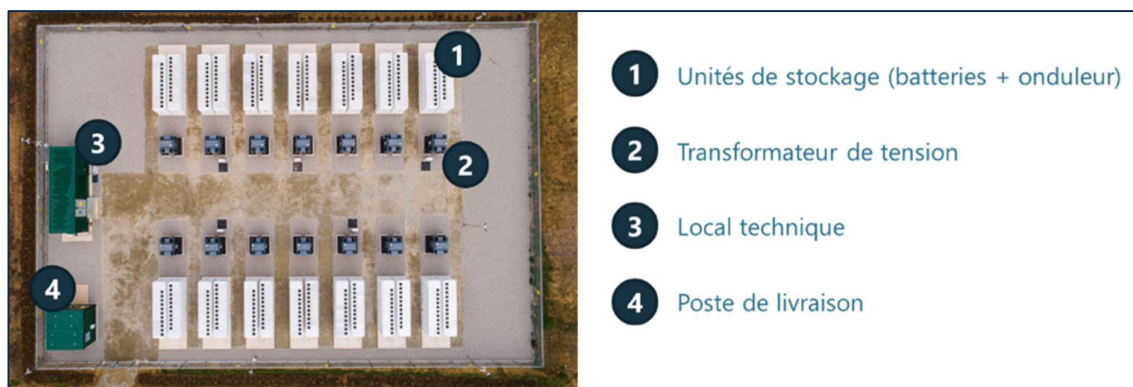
PLAN DE PRINCIPE D'UNE INSTALLATION DE STOCKAGE PAR BATTERIES
